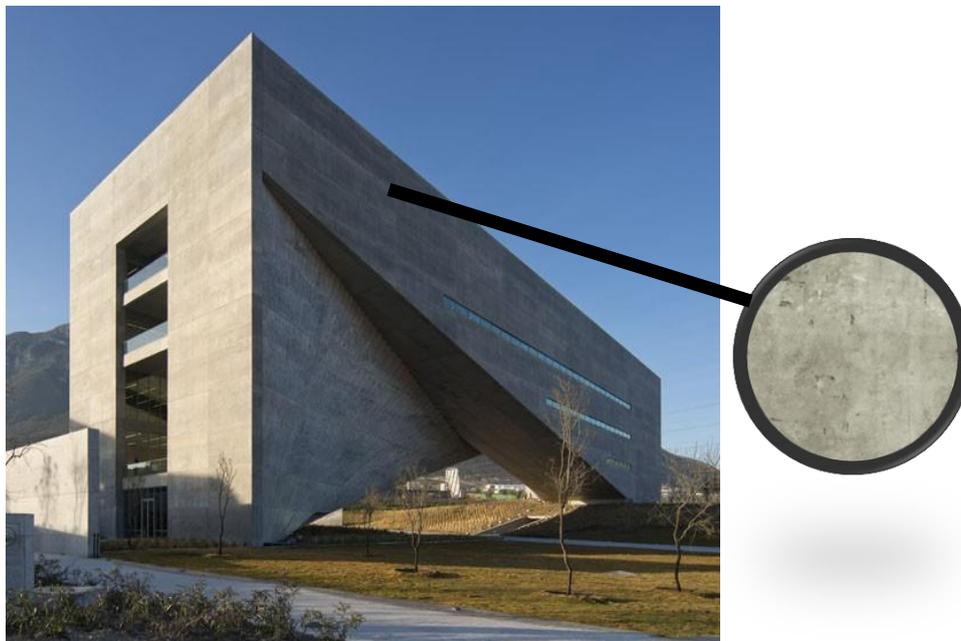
Edificação de concreto aparente na fachada - Disponível em: Fonte: <https://casavogue.globo.com/Arquitetura/Edificios/noticia/2013/11/mexico-ganha-obra-de-tadao-ando.html> /Acessado em 02/06/20
